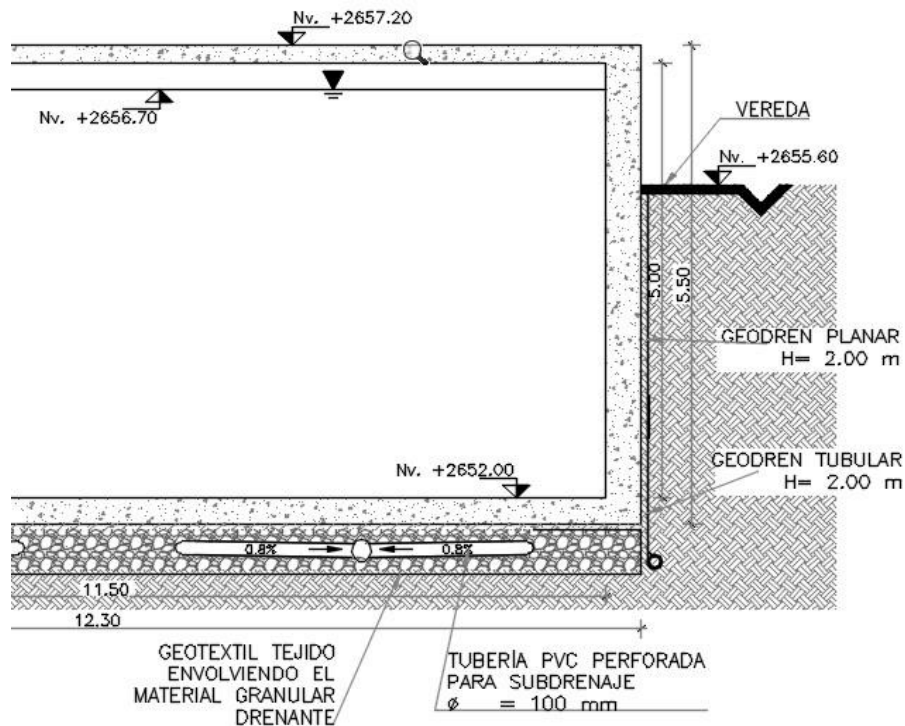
Tubería De Subdrenaje Llano Grande Alto Vista En Corte
